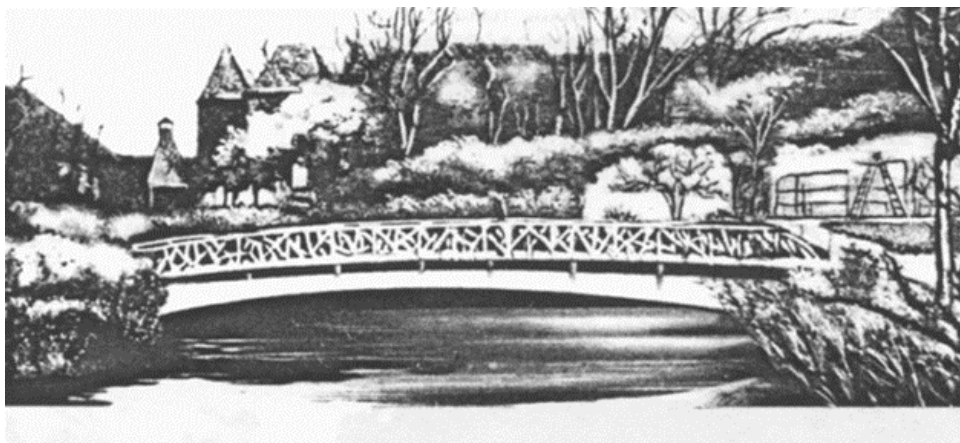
Primeira ponte construída em betão armado (Joseph Monier, 1873)
